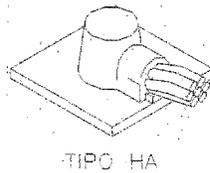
Soldadura para conexión tipo HA.
